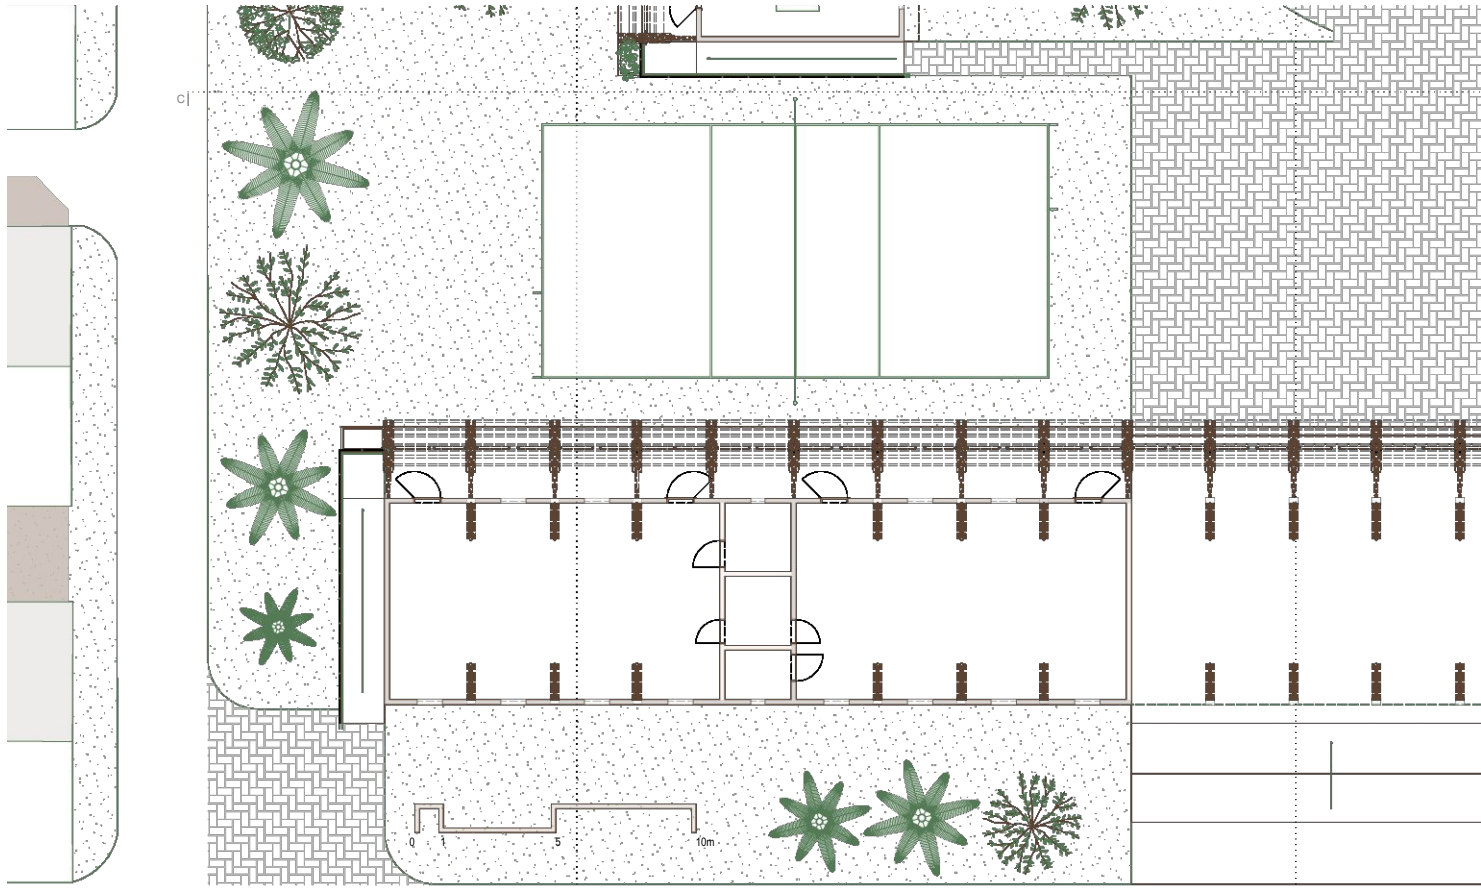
Grundriss Gemeinschaftsriegel
